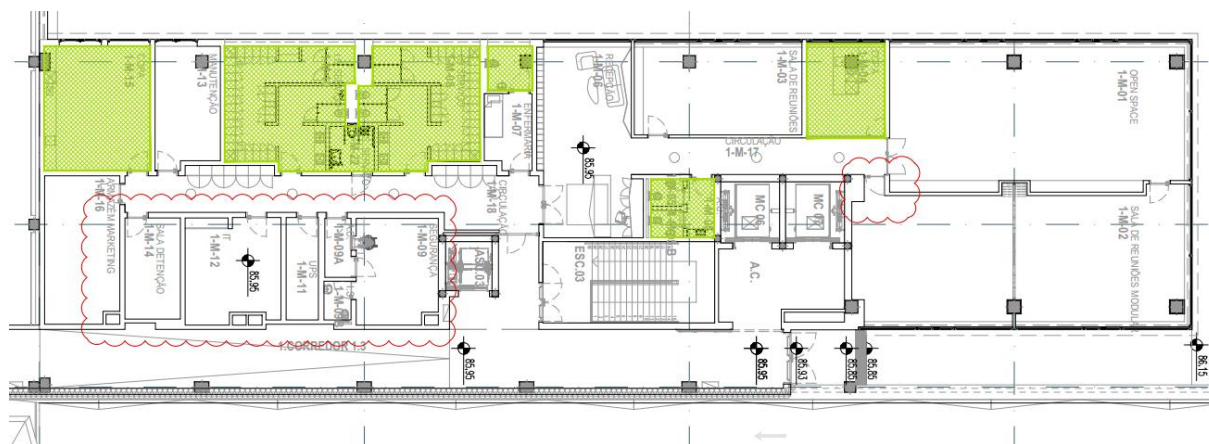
Planta de impermeabilizações da administração (Verde – Locais a impermeabilizar)
